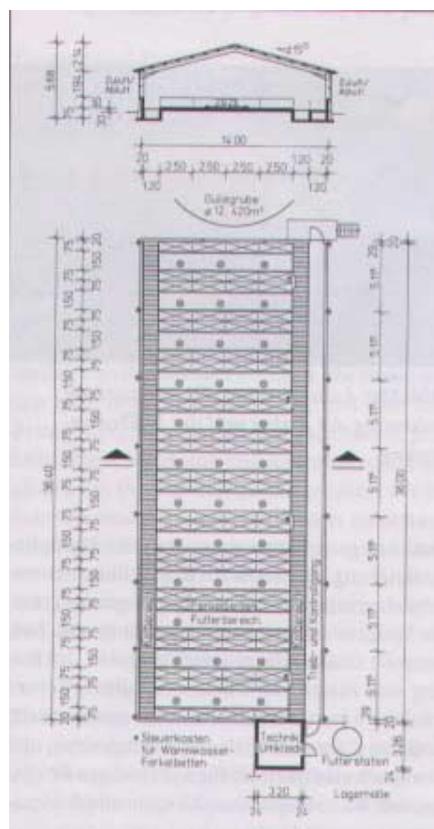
Grundriss Außenklimastall mit Ferkelbetten (Quelle: KTBL)
